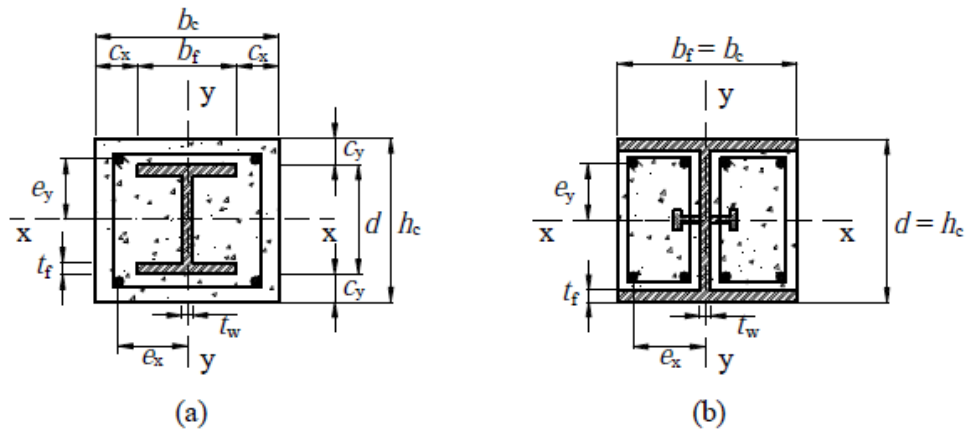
Tipos de seções transversais de pilares mistos revestidos;
